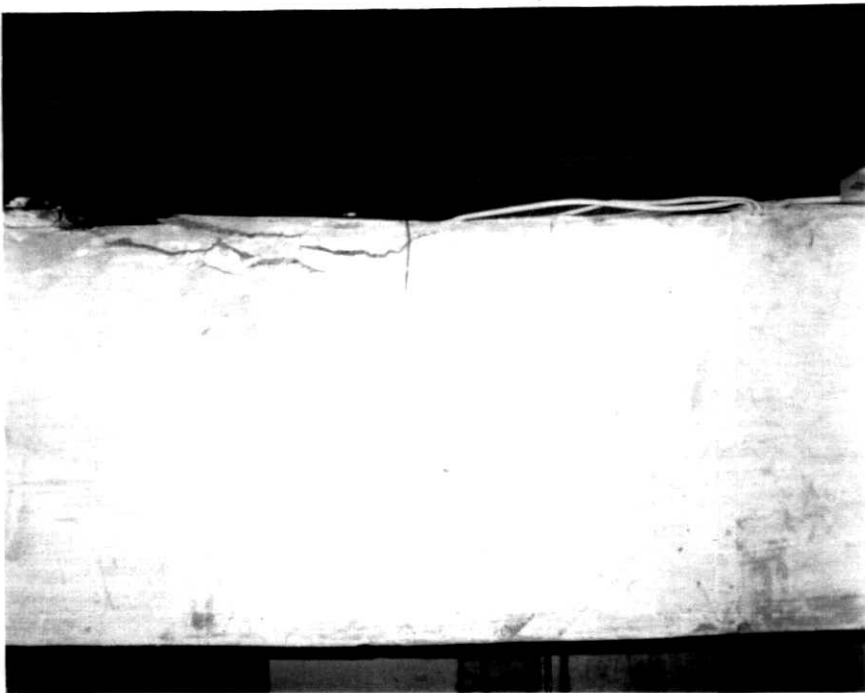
Ruptura da viga V5 - esmagamento do concreto após o escoamento da armadura longitudinal
